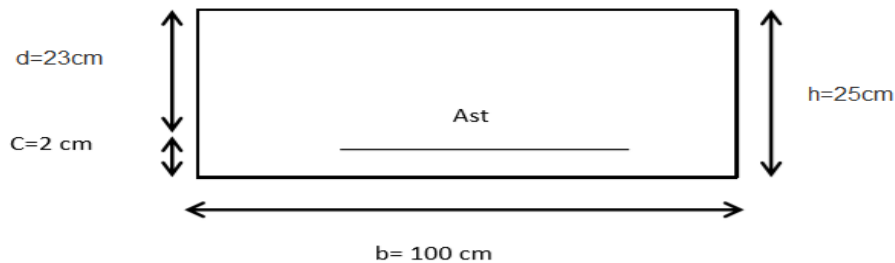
Schéma statique de ferrailage du voile périphérique.
